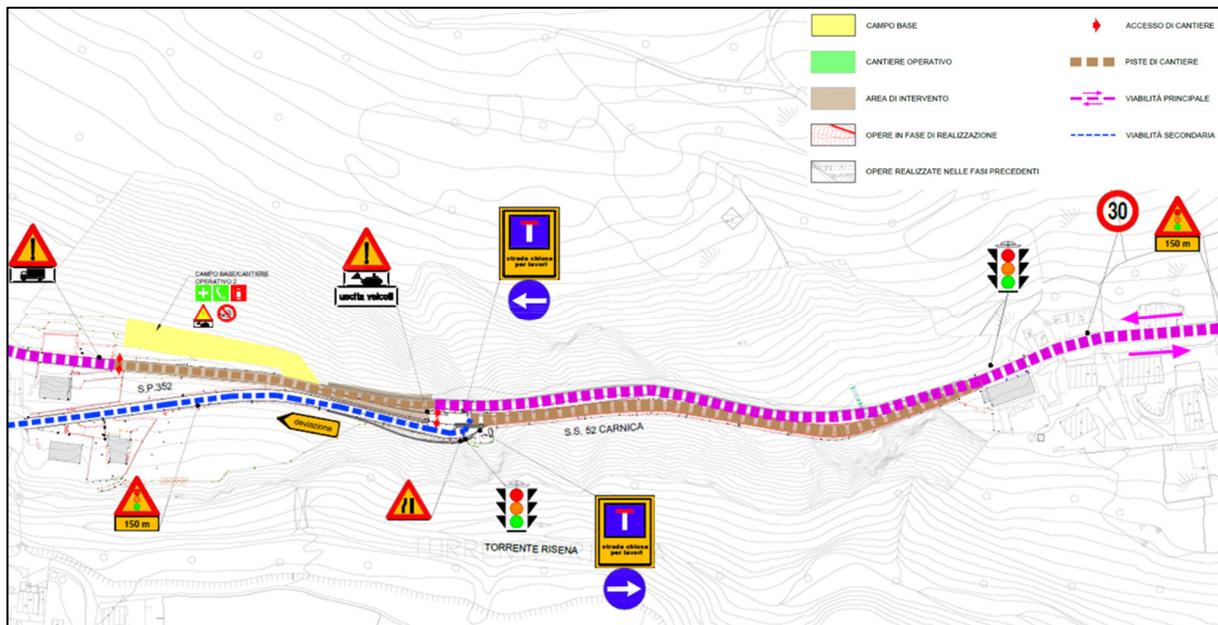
Cantierizzazione Fase 4 – Estratto elab. T00CA00CANPL02A
